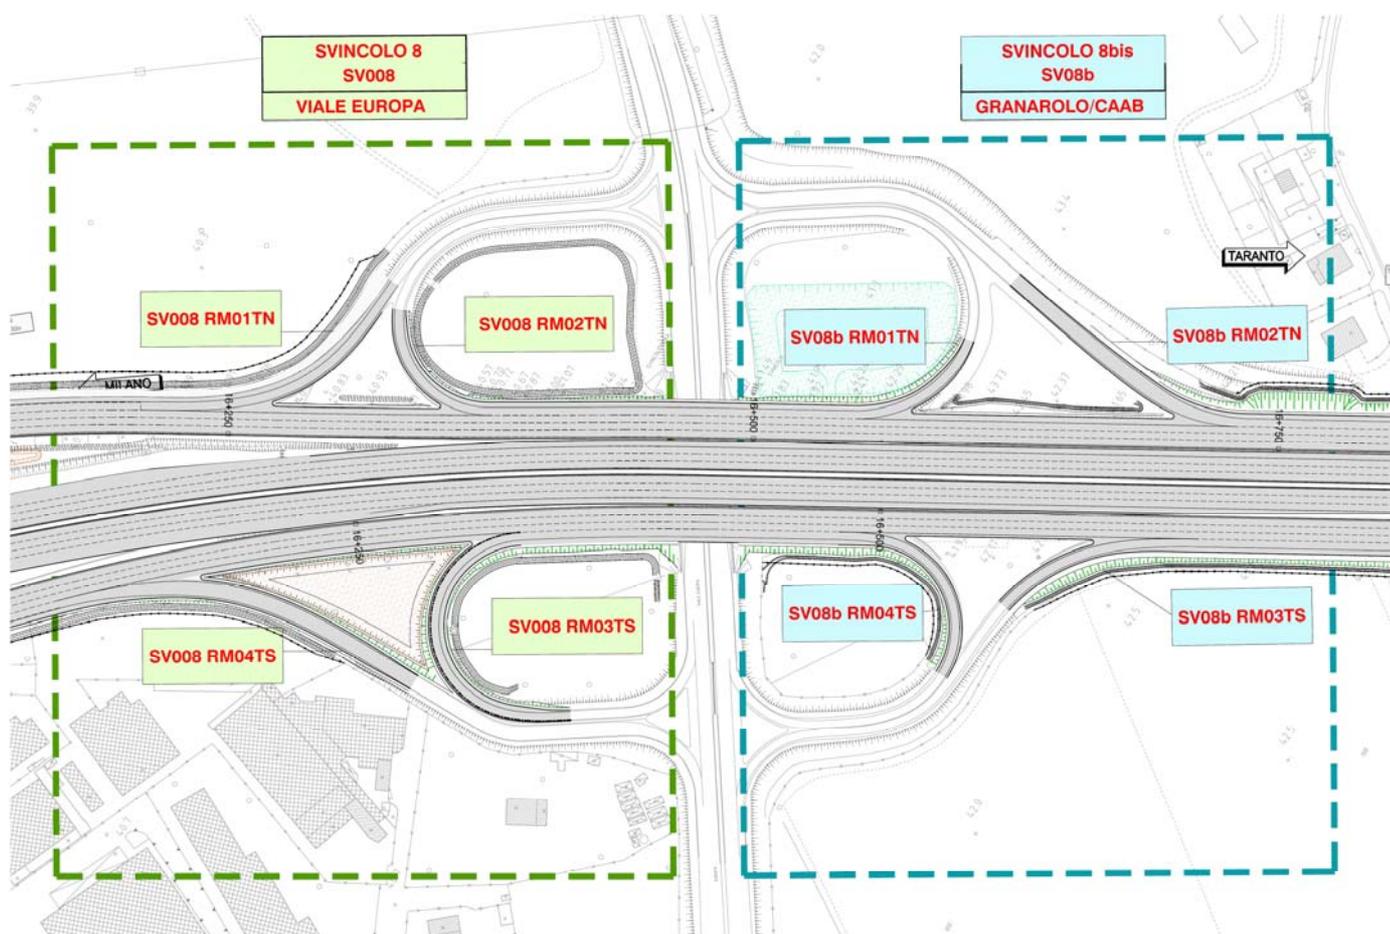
Stralcio planimetrico svincolo n.8 e 8b
